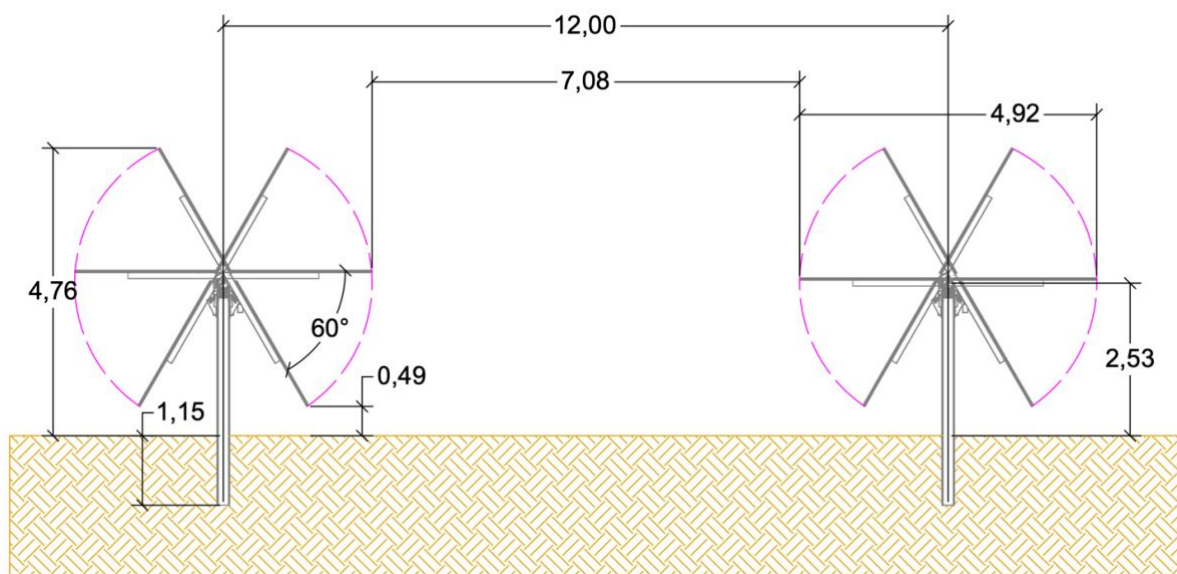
Vista delle strutture fotovoltaiche in sezione.
